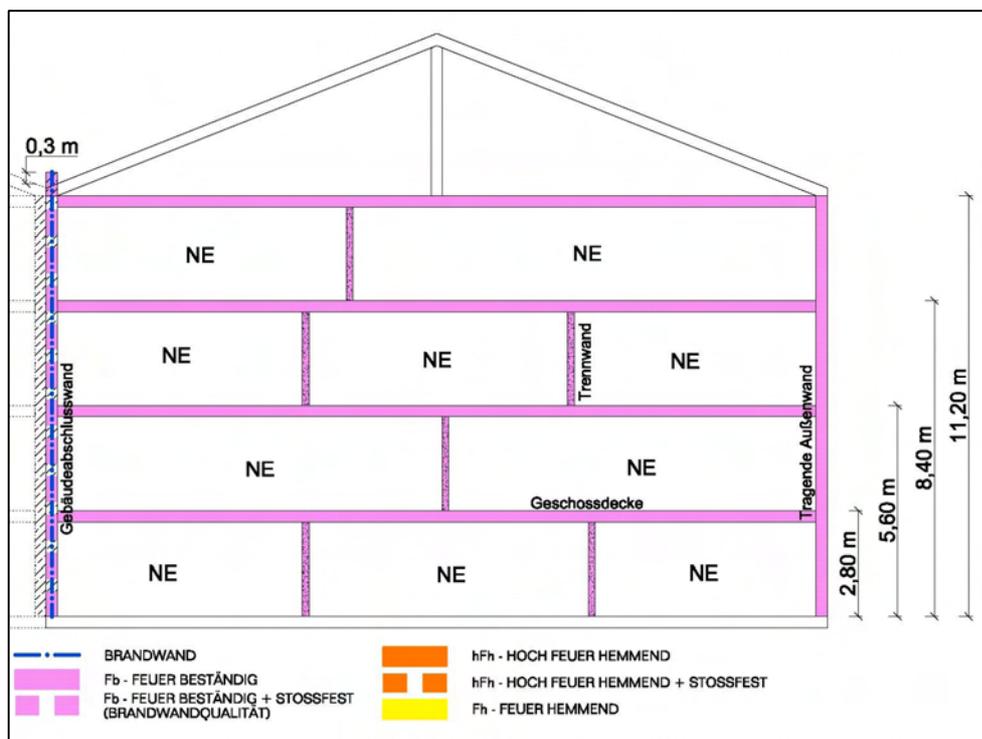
Gebäudeklasse 4 nach HBauO 1986 bewertet; eigene Darstellung
